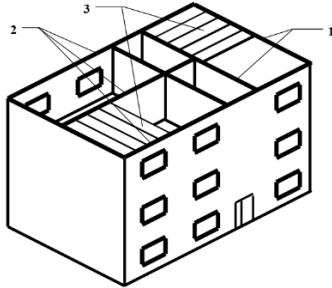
Будинок стінової конструктивної системи: 1 – несучі поперечні стіни; 2 – несучі поздовжні стіни; 3 – панелі перекриття
